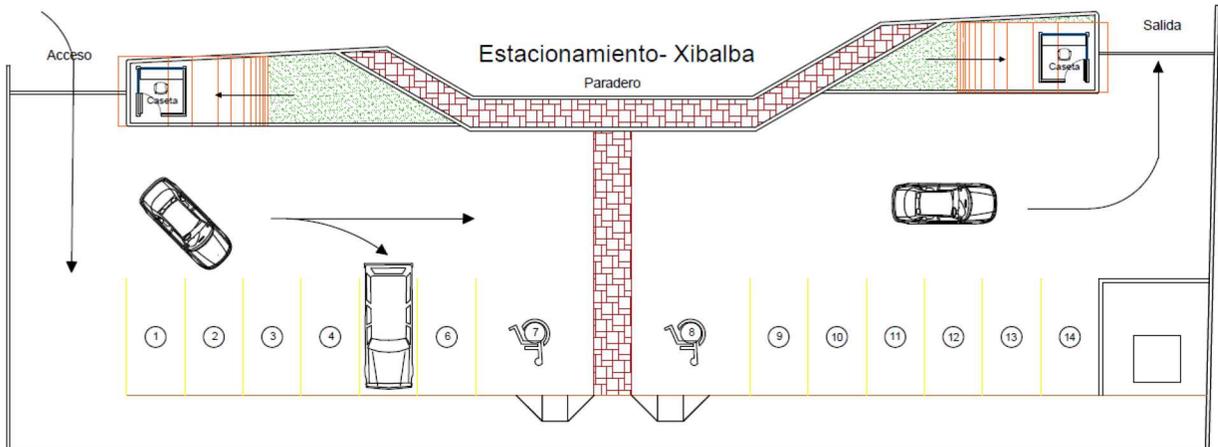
Vista de planta de conjunto de acceso, caseta de vigilancia y estacionamiento del proyecto.
